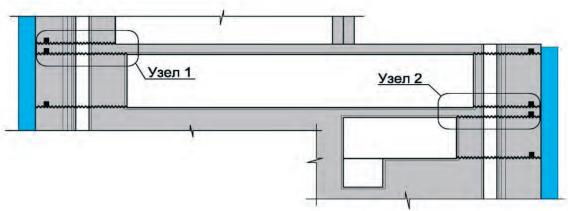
Схема расположения швов бетонирования и гидроизоляционного жгута «Пенебар» в местах сопряжения стен и перекрытий в машинном зале и технологических помещениях здания Γ ЭС (фрагмент 1 на рис. 6.1.1)
